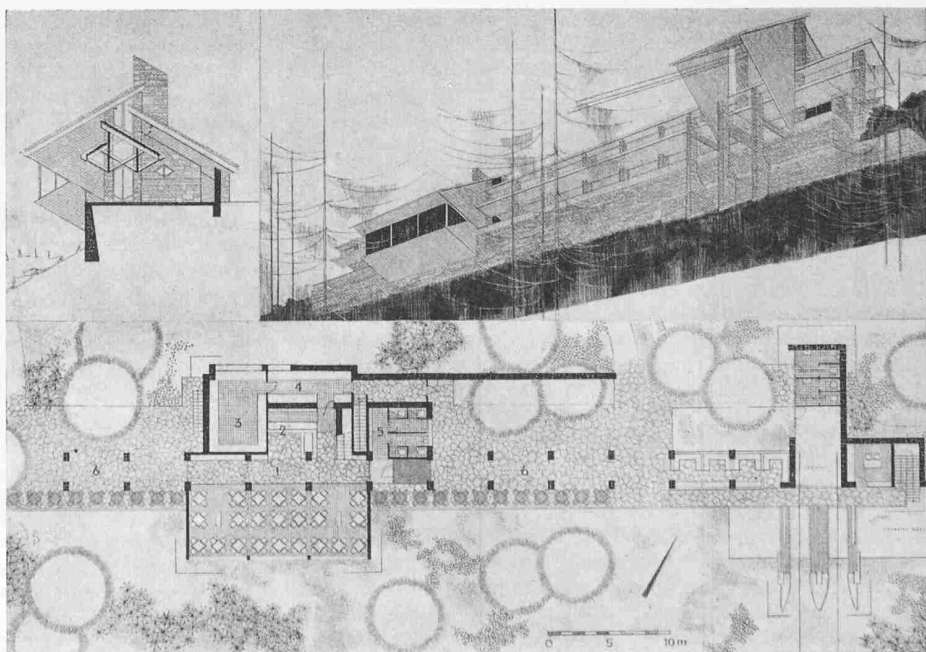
Primo progetto, facciata est del ristorante e pianta 1:600, prospettiva
